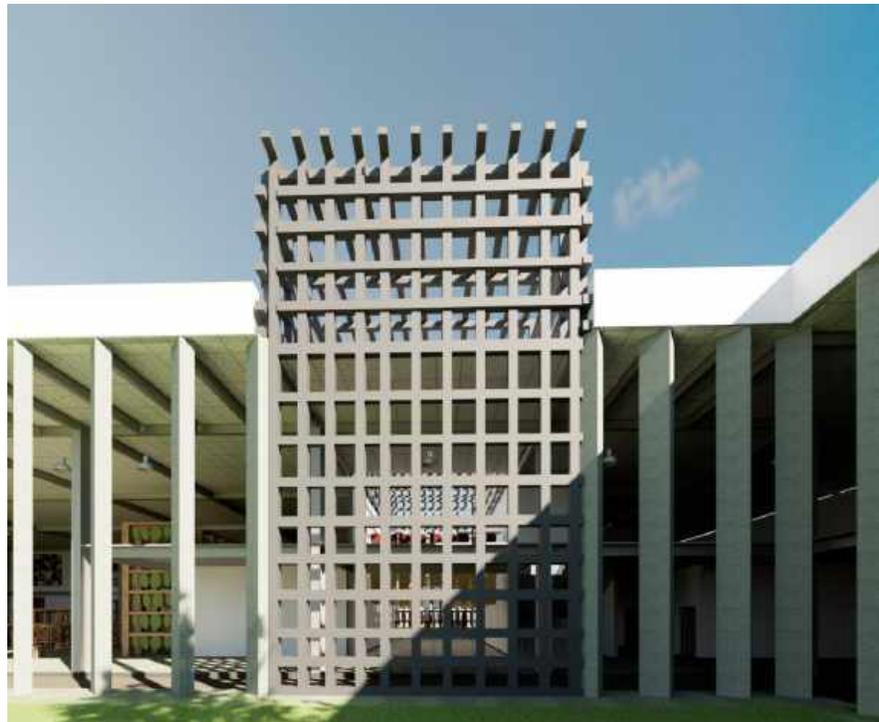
Vista exterior del área de venta y Galería de exhibición.
